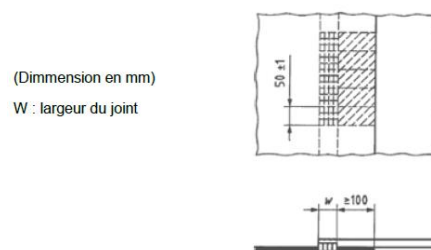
prélèvement et dimensions des éprouvettes (NF 12316-2)
